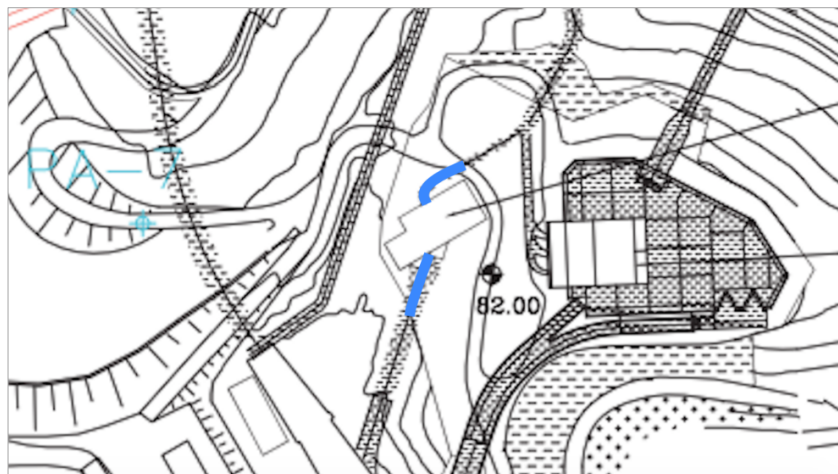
Obra civil a construir en la solución de la central en el río Júcar. Elaboración propia.
